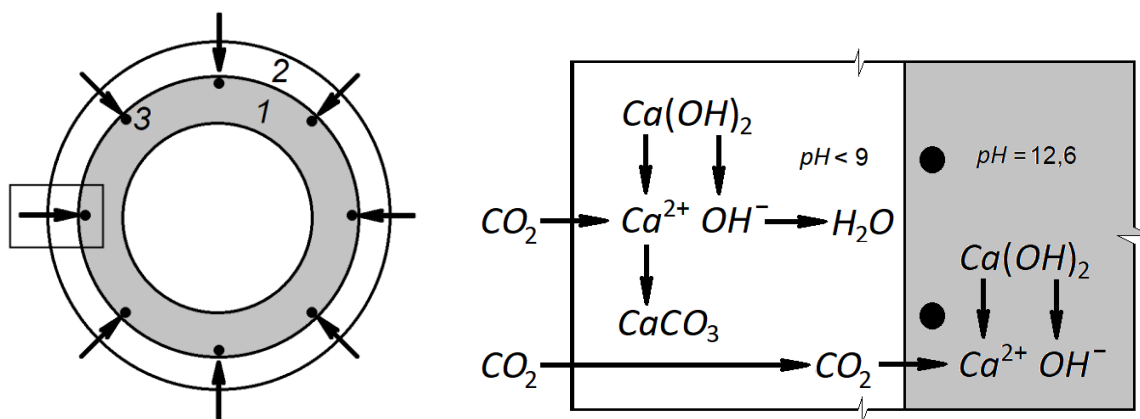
Схема просування карбонізації бетону захисного шару в поперечному перерізі опори контактної мережі: 1 – некарбонізований бетон; 2 – карбонізований бетон захисного шару; 3 – робоча арматура
